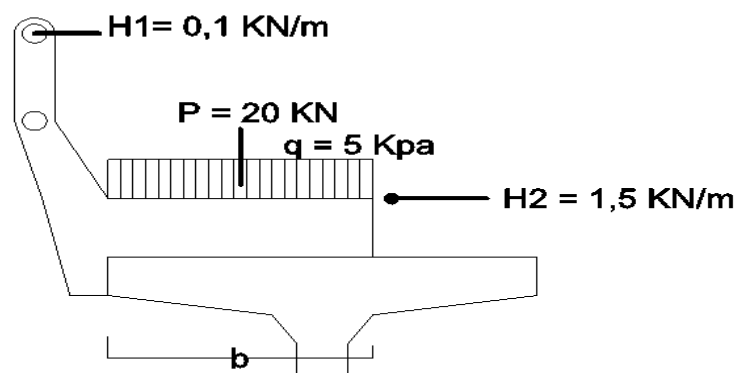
Panjang , Lebar dan Potongan Trotoar
